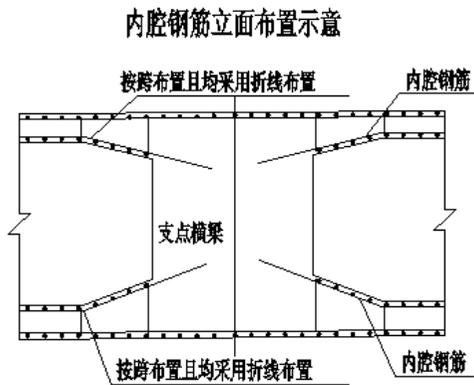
箱梁钢筋-各孔内腔钢筋布置-折线布置
